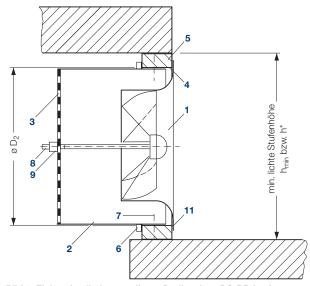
Einbaudetail, dargestellt am Drallauslass DS-DD in einer Holzstufe
